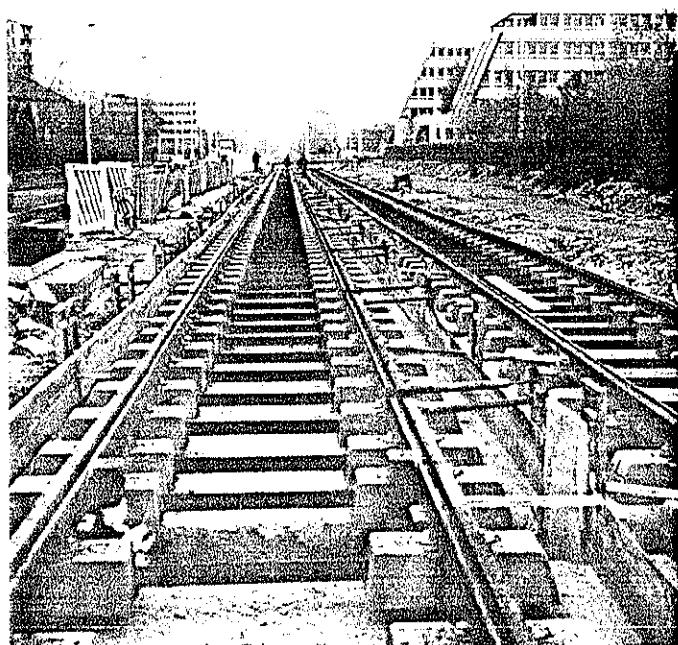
Pose de voie semi-directe : traverses blocs sur dalle en béton avec semelle intermédiaire en caoutchouc (photo Métram).
